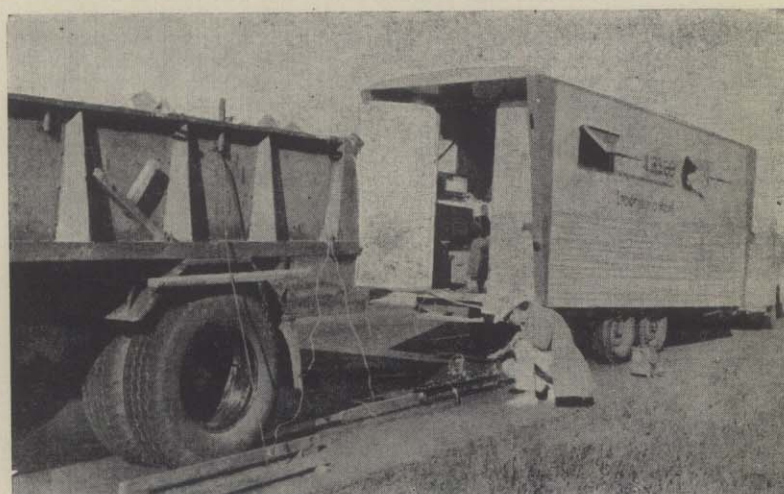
Conjunto de los dispositivos montados sobre el pavimento.
